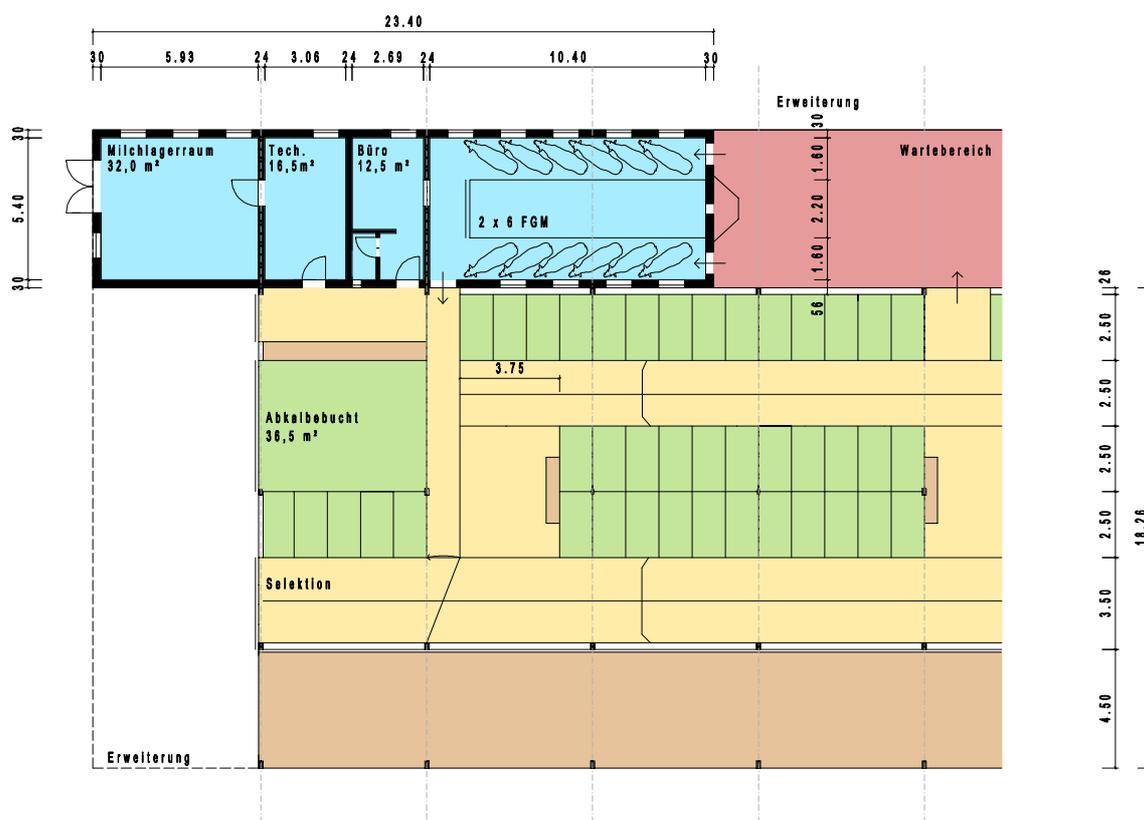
Grundriss für ein seitliches Melkhaus mit 2 x 6er Fischgrätenmelkstand, Wartebereich und separatem Selektions- und Abkalbebereich
